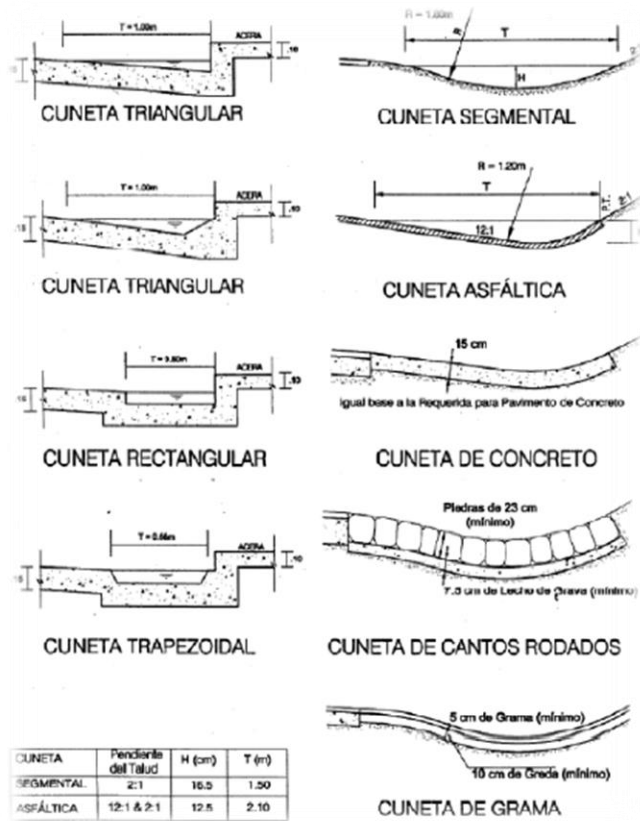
Sección transversal de Cunetas. Adaptado de (RNE OS.060)
